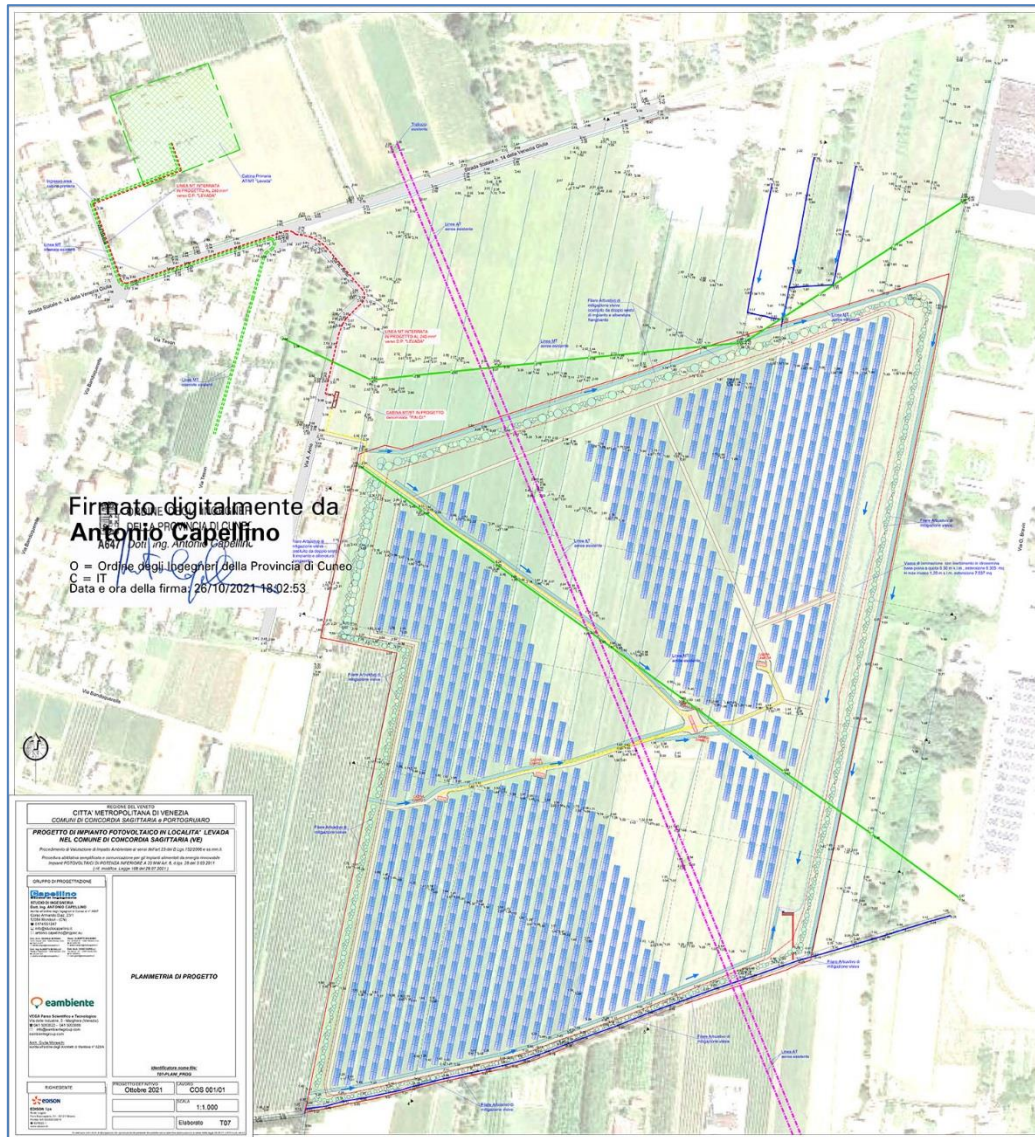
VECNC22lev, piano dell’impianto finale previsto dal progetto.
